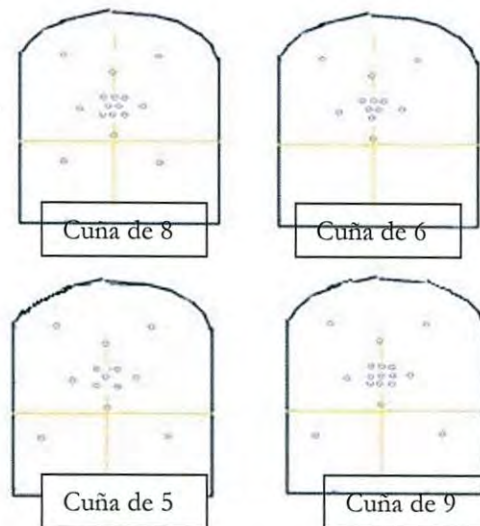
4 tipos de plantillas de barrenación horizontal donde la cuña es colocada al centro de la labor.
